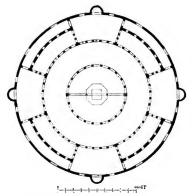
St. Stefano rotondo in Rom. Grundriss.
